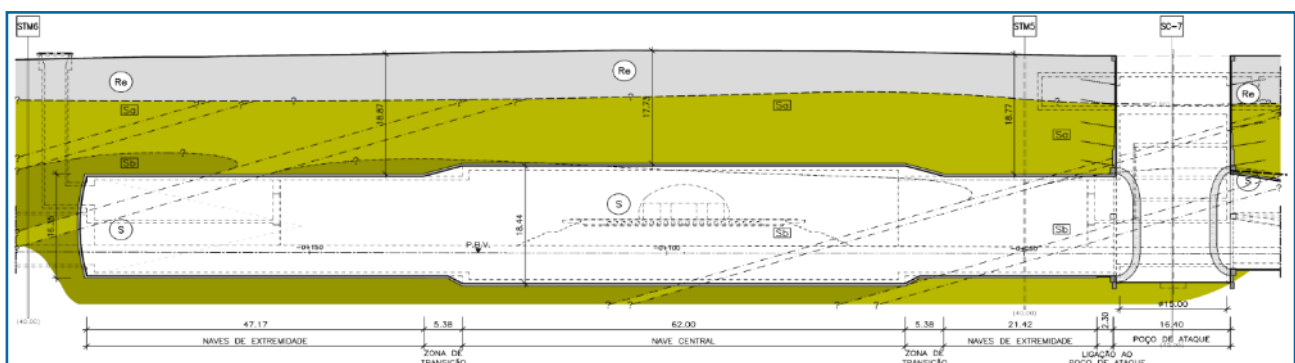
Corte longitudinal da estação – recobrimento de ~18m
